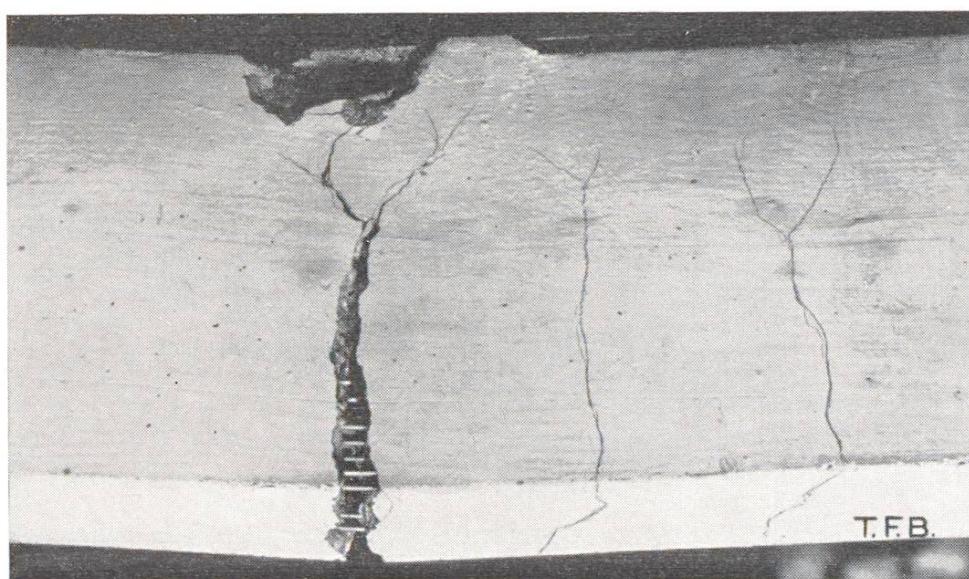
Poutre d'essai en béton précontraint après l'essai de rupture. Fissuration caractéristique (Essais de Schinznach, S.I.A.)
